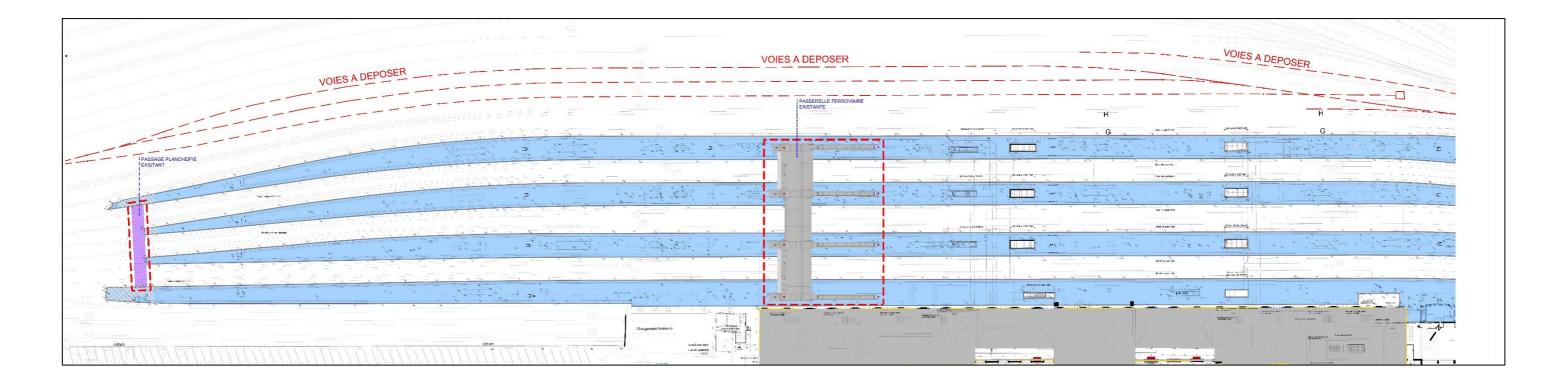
Elévation ouest de la passerelle -coupe sur le plan de voies
